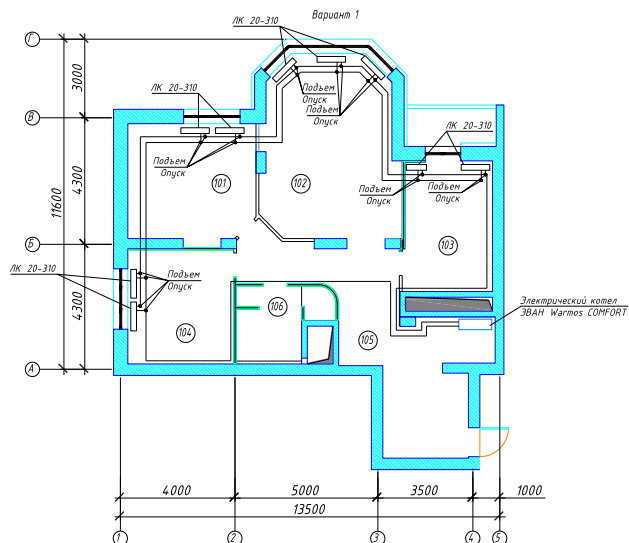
План трехкомнатной квартиры с угловыми помещениями с горизонтальной системой отопления с радиаторами (Вариант № 1)
